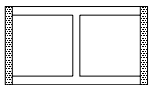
Planta Torre Británica. Distribución simétrica de muros
